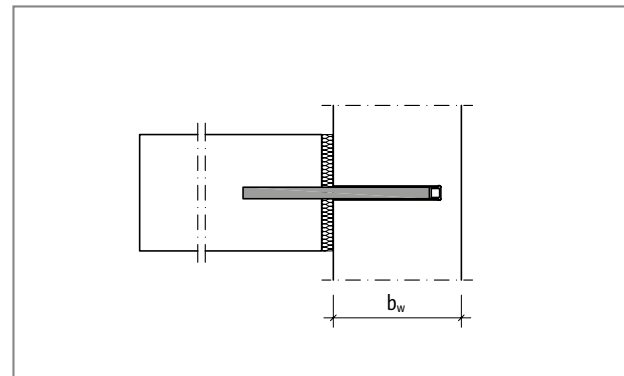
Schöck Dorn type LD : Épaisseur minimale de l'élément de construction d'un mur ou d'un poteau
